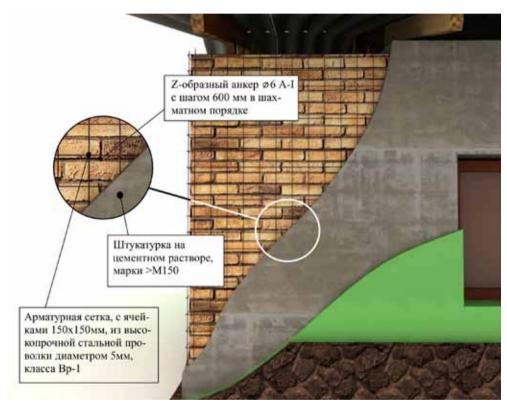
Усиление стен из жженого кирпича армированным цементным раствором
